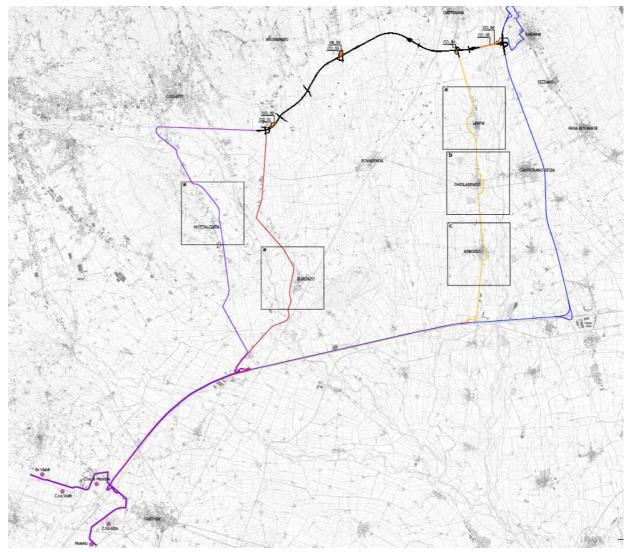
Percorsi previsti per l'approvvigionamento del materiale dai mezzi di cantiere – stralcio elaborato "Cantierizzazione: ubicazione delle aree di cantiere e viabilità di servizio"
